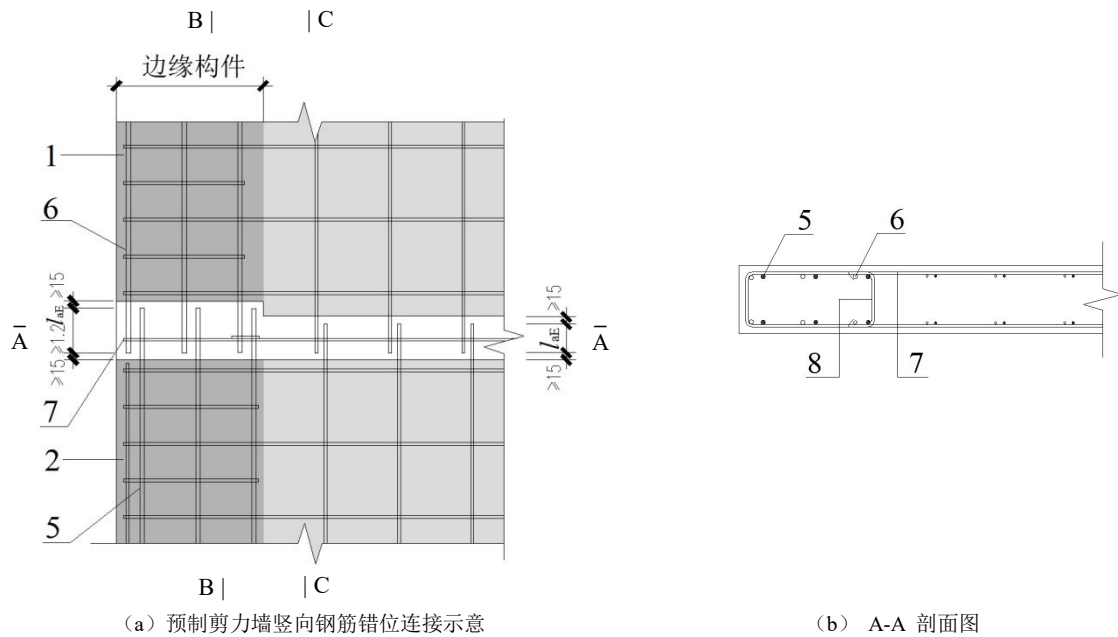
预制剪力墙竖向钢筋错位连接示意
